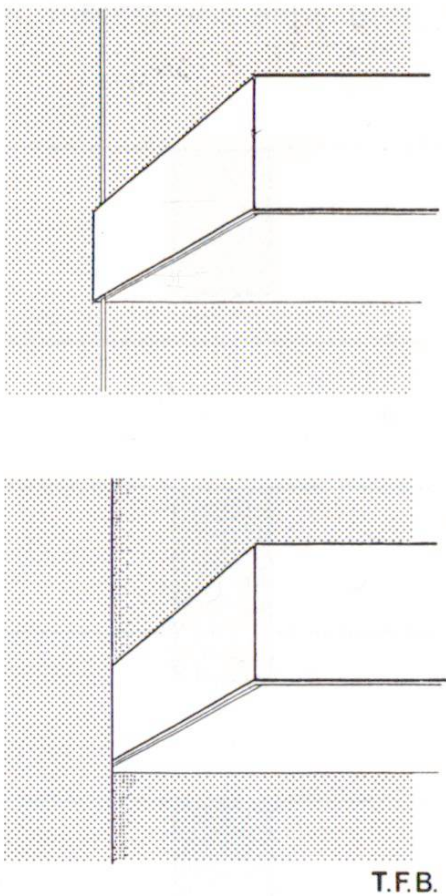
Élément en saillie, par exemple dalle de balcon. En haut: Rainure verticale d'écoulement correspondant à la «goutte pendante». En bas: Le mur de la façade est un peu en retrait.
